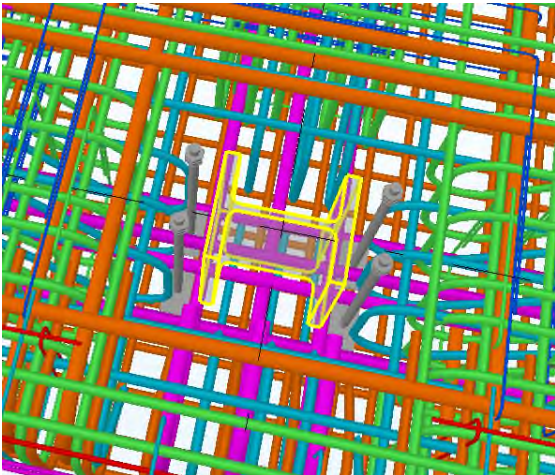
Detalle de Tekla de conexión cimentación / pilar con llave de cortante
